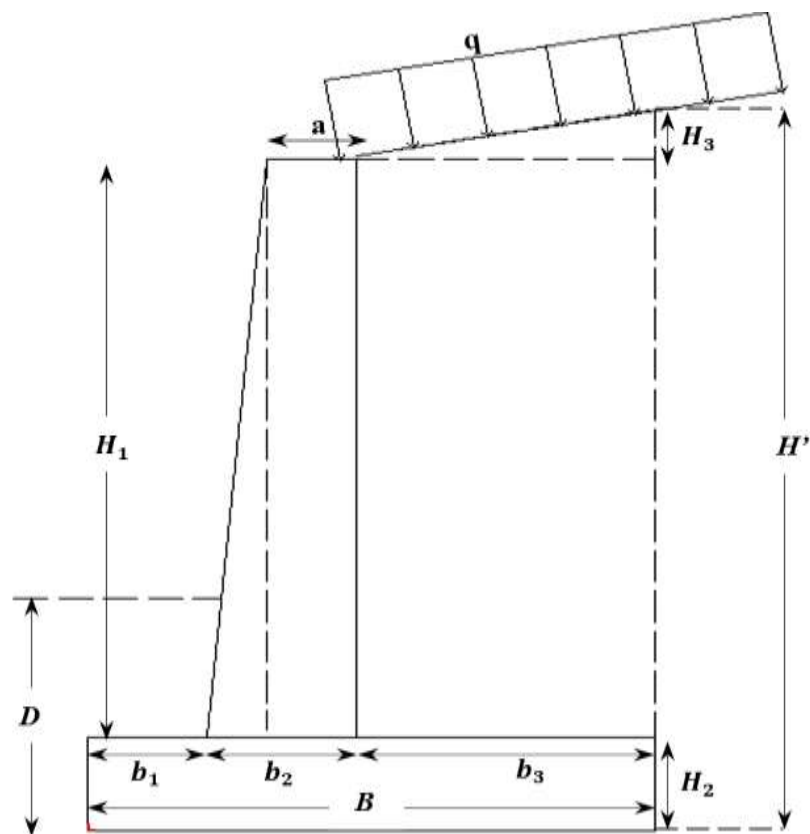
Dimensionamiento del muro tipo voladizo.
